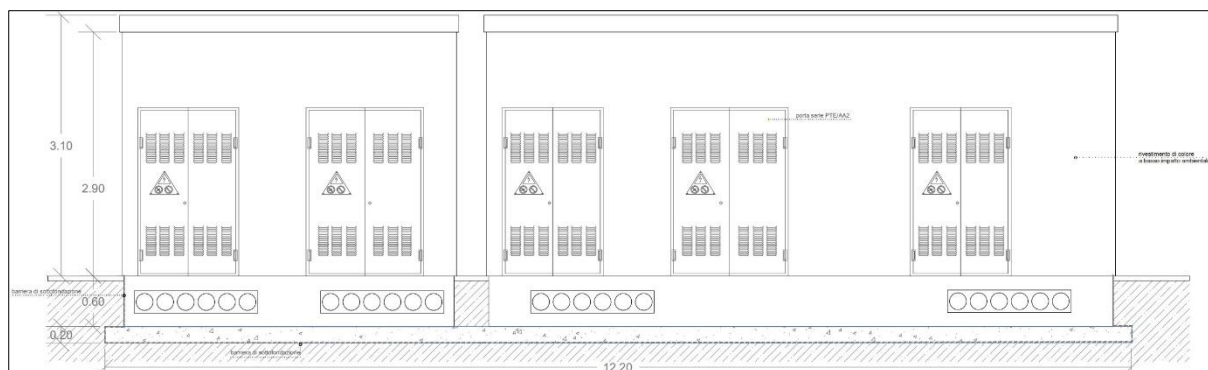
Prospetto struttura di fondazione cabina di sottocampo
